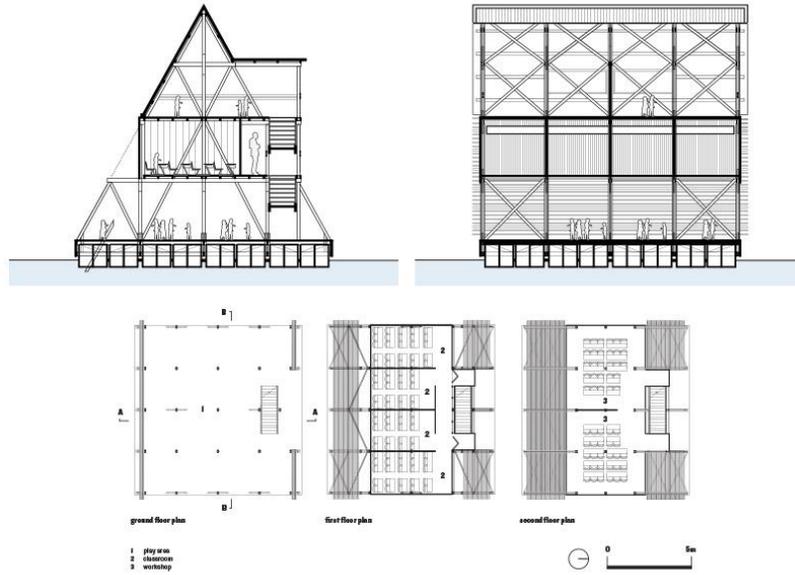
Plantas y Cortes Arquitectónicos - Floating School - NLe Architect
